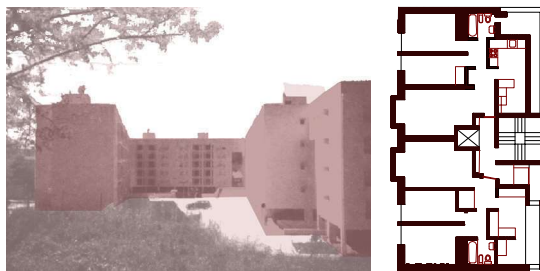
Prémio INH 2002 - fotografia e planta habitação tipo
